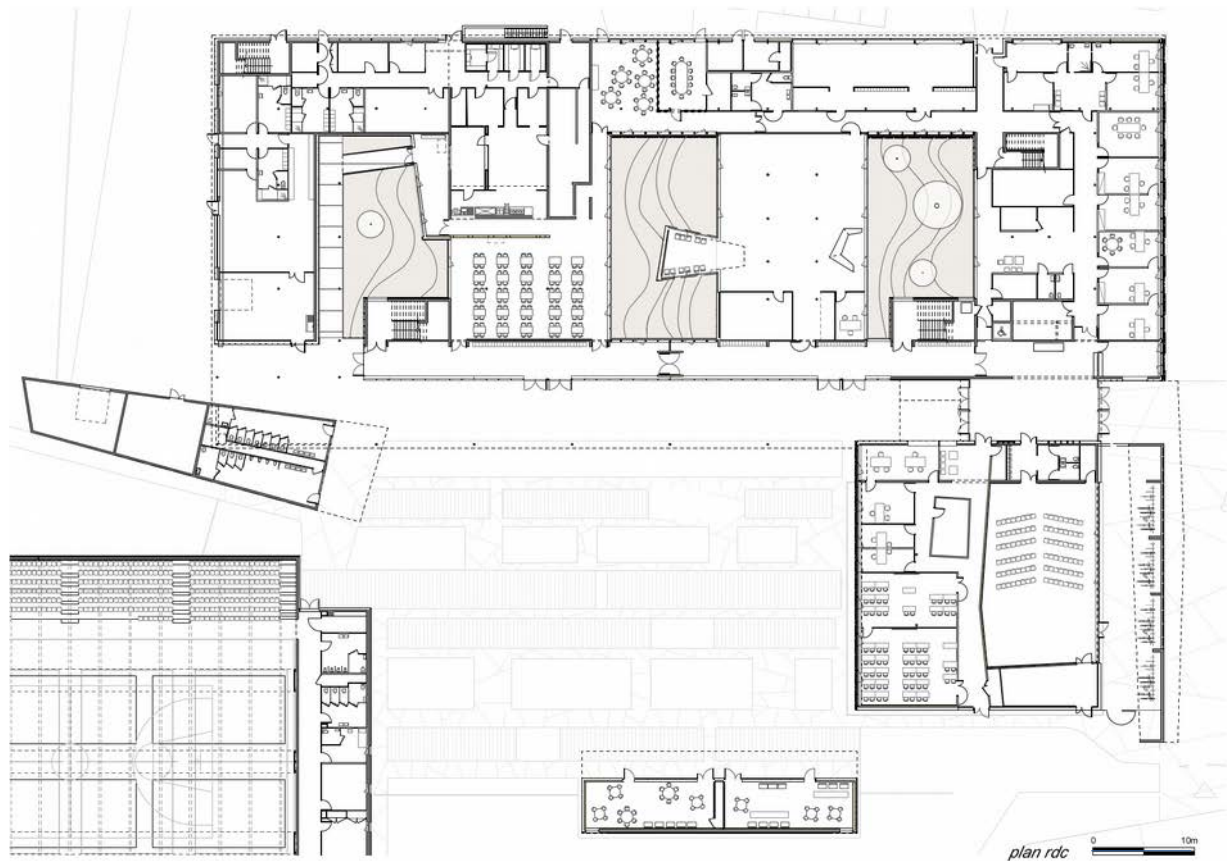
Plan de l'architecte au 1/750° (rez-de-chaussée), sur lequel on distingue notamment les trois patios structurant le bâtiment principal. Le rez-de-chaussée répartit aisément les différentes fonctions, relativement aux publics auxquels elles sont destinées.
